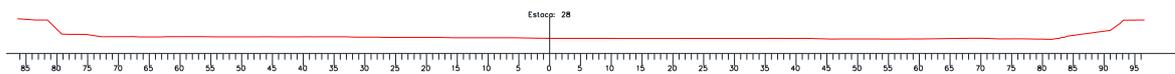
Seções transversais sobre o perfil estaqueado de 20 em 20m
